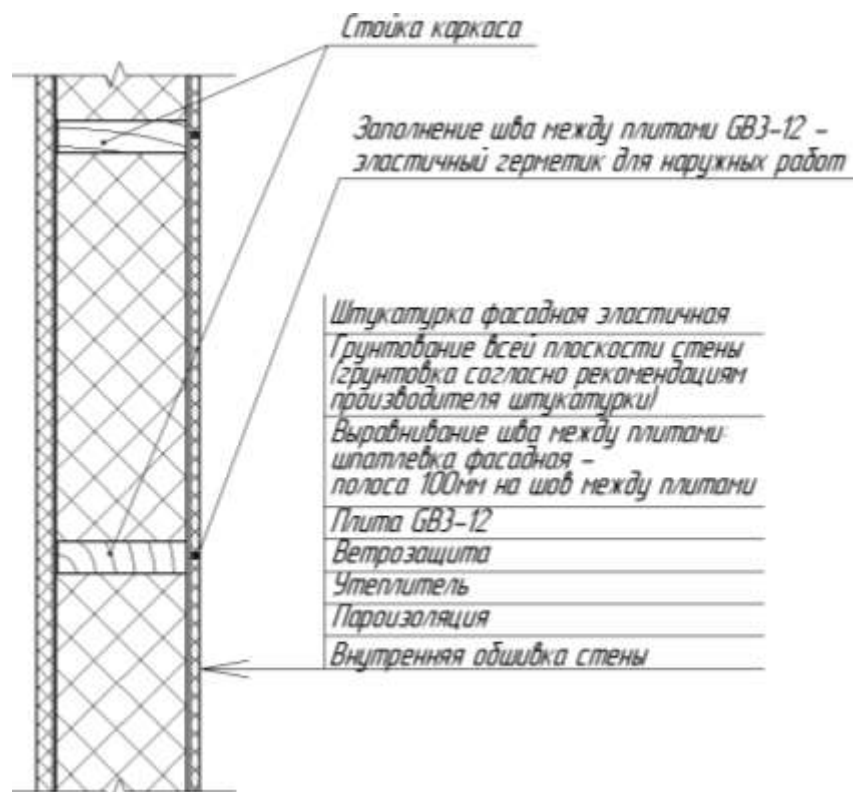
Разрез стены со швами с обшивкой плитами в вертикальном направлении без наружного покрытия. Вид сверху.
